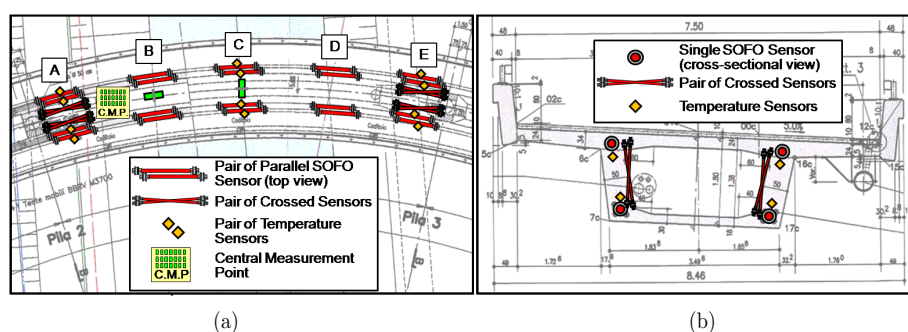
Plano de instrumentação adoptado durante a construção da Ponte Ricciolo: a) representação esquemática em planta; b) representação esquemática em corte transversal na secção-tipo (Glisic et al., 2008, 2010).
